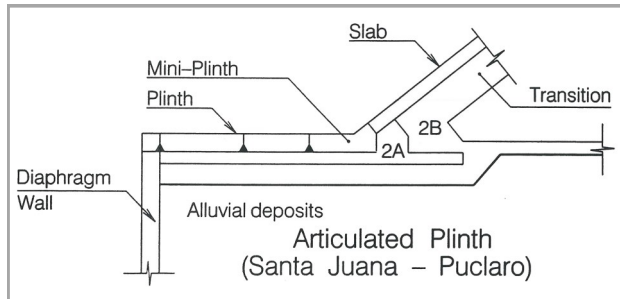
Esquema del sistema pared moldeada-plinto articulado-pantalla de hormigón
